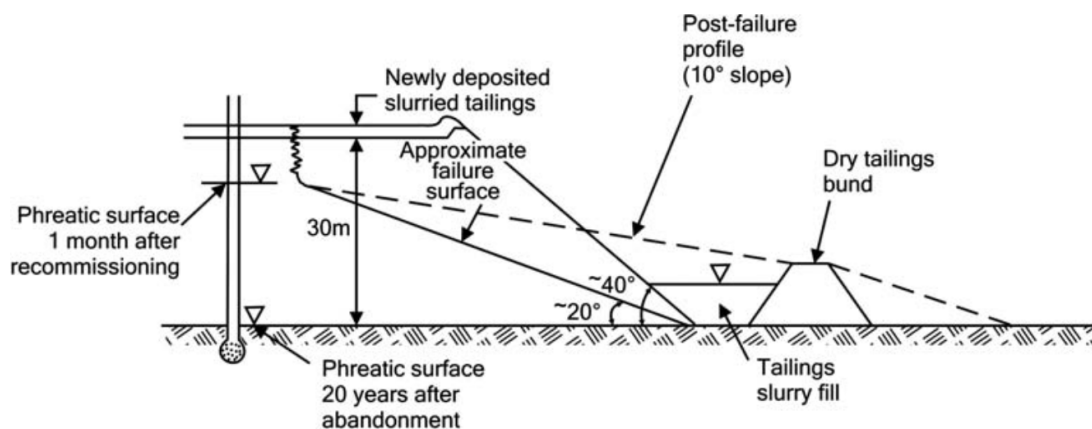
Seção transversal da barragem Simmergo (adaptado de BLIGHT, 2010).
